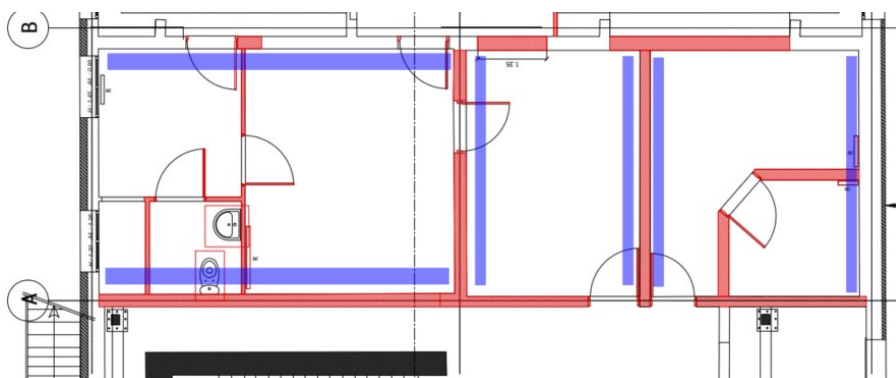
Etalement des planchers (en bleu, sur plan de démolition architecte)
